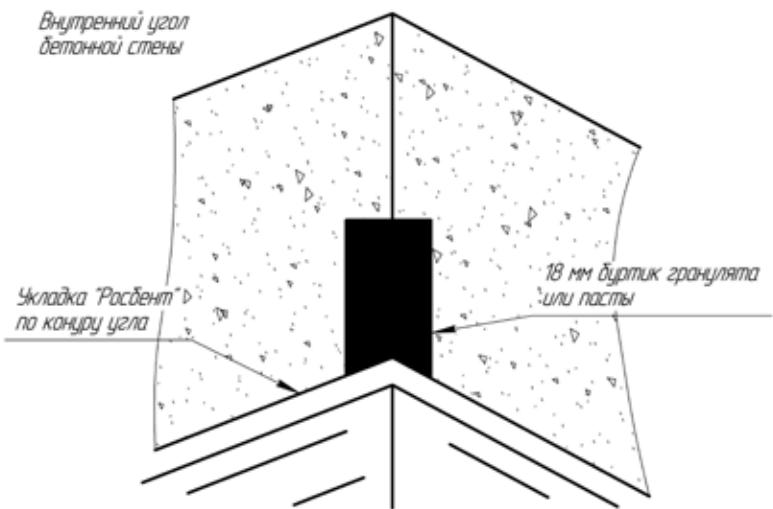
Гидроизоляция внутреннего угла, образованного стенами и фундаментной плитой
